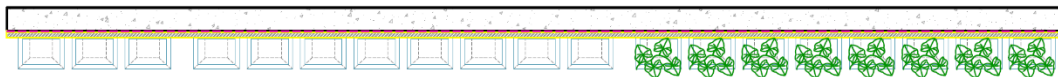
Planta com os vasos e a vegetação em fase de crescimento.
